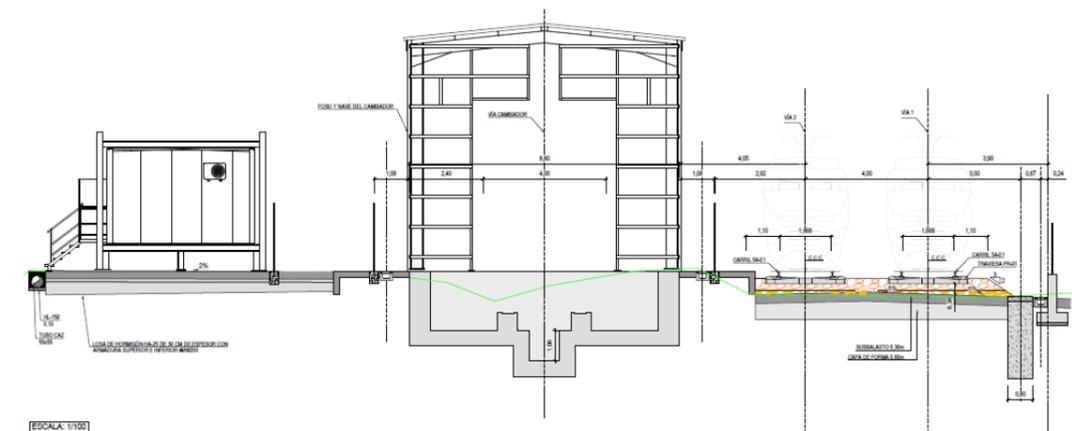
Sección del cambiador de ancho propuesto. Fuente: INECO.
